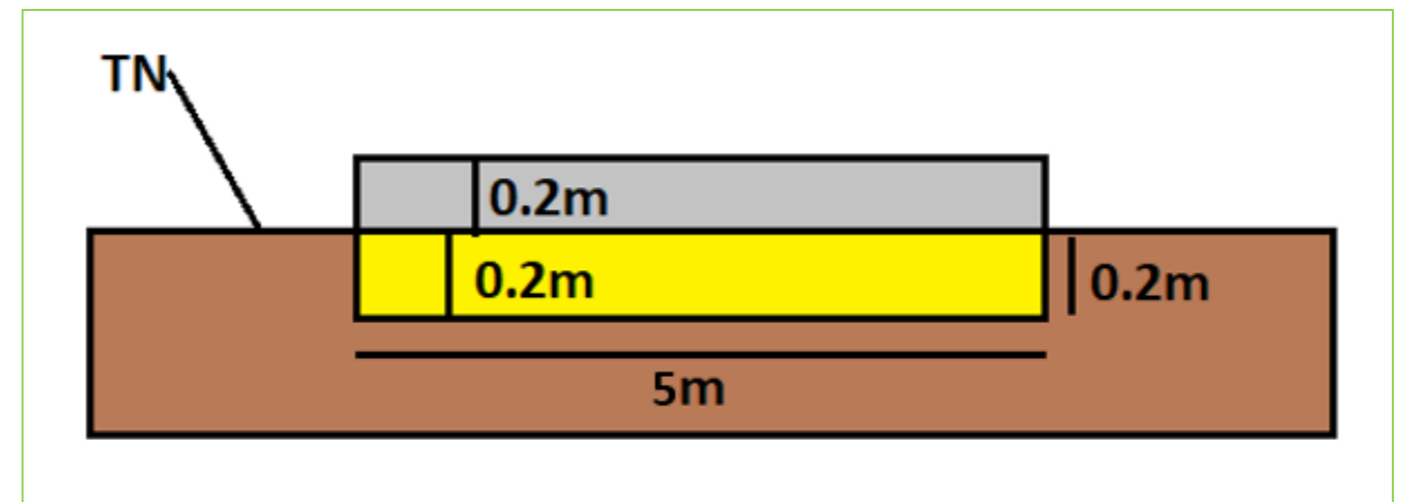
Coupe type d'une piste lourde (source : PHOTOSOL)
